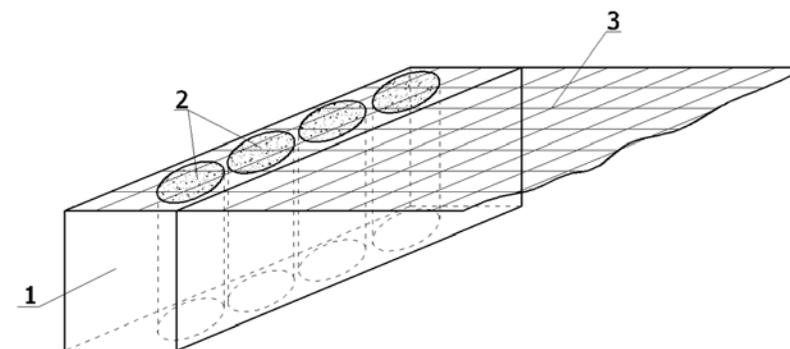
Железобетонный блок конструкции С. Г. Жорняка:
